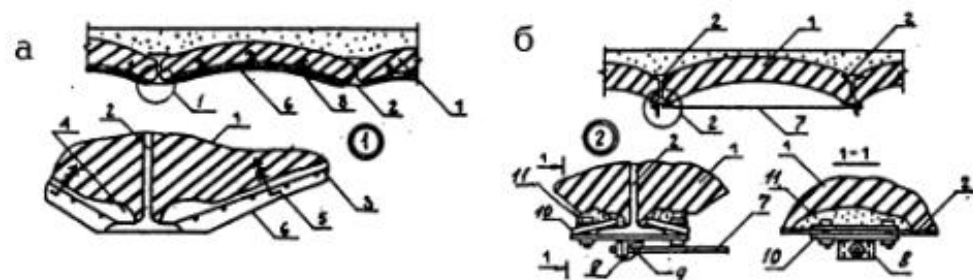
Усиление перекрытия из кирпичных сводков: а – подведением монолитной сводчатой плиты; б – стальными затяжками; 1 – кирпичный сводок; 2 – стальная балка; 3 – арматурная сетка; 4 – паз для опирания железобетонного сводка; 5 – ерши, крепящие арматурную сетку к кладке; 6 – железобетонный сводок; 7 – стальная затяжка; 8 – уголок для крепления затяжки; 9 – ребро жесткости уголка; 10 – система крепления опорного уголка к стальной балке; 11 – цементный раствор
